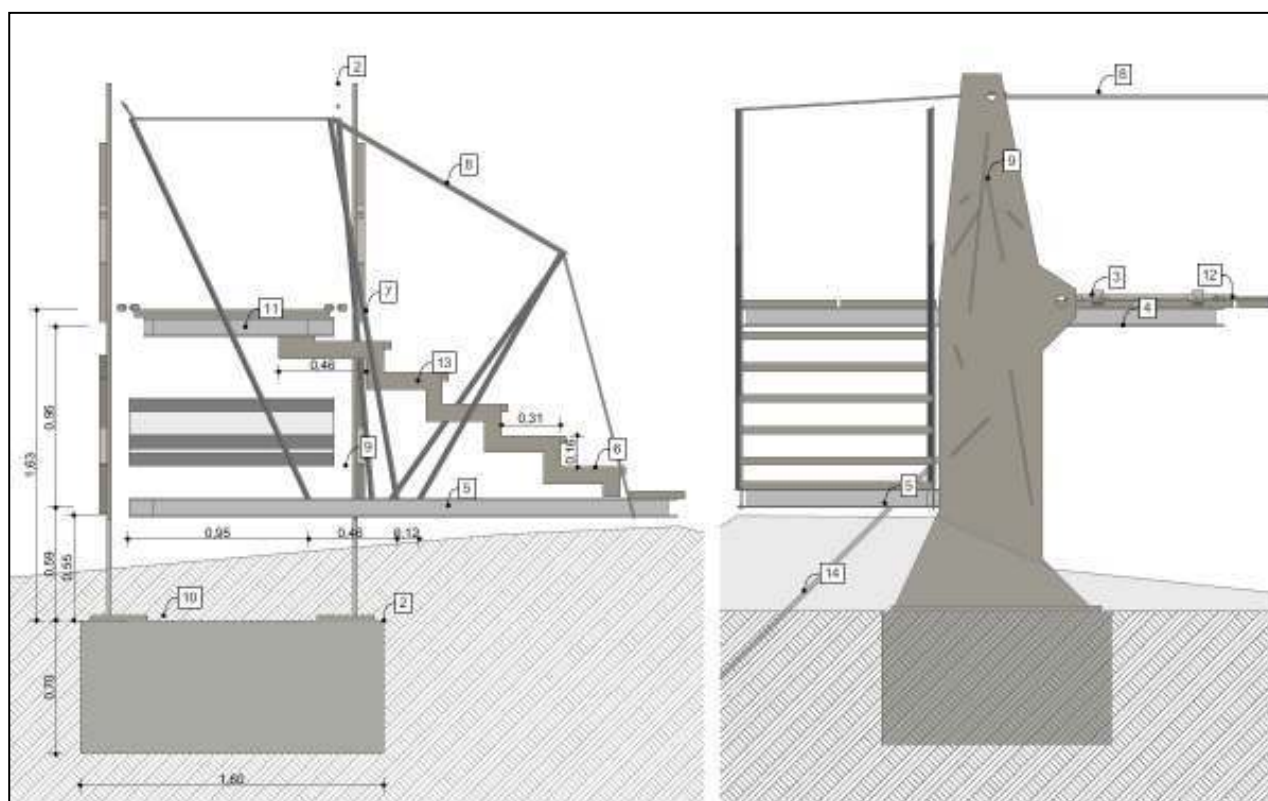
Prospetti laterali delle spalle della passerella
